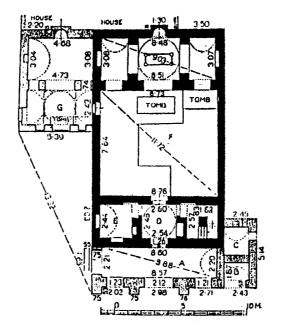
مسقط أفقي لجامع محمد علي بالقاهرة . (عن : هوتكيروفييت) .
